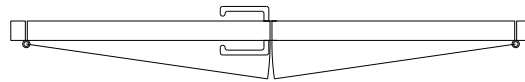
Detalle en planta de Puerta Batiente Peatonal de 2 hojas.
